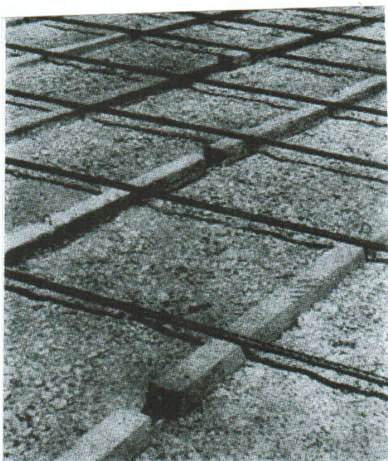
De lussen der betonribben zijn verspringend. Door de ribben worden de dwarswapeningsstaven op de juiste hoogte gehouden.
